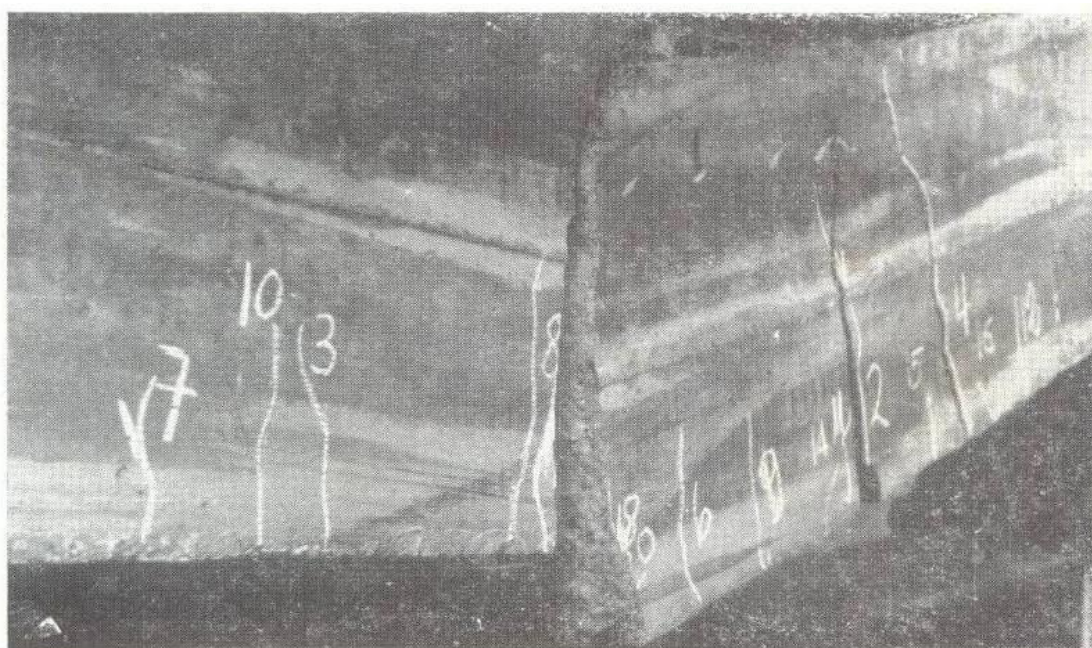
Uma das vigas de concreto armado ensaiadas no Instituto Nacional de Tecnologia , numa pesquisa em curso sobre fissuração.
